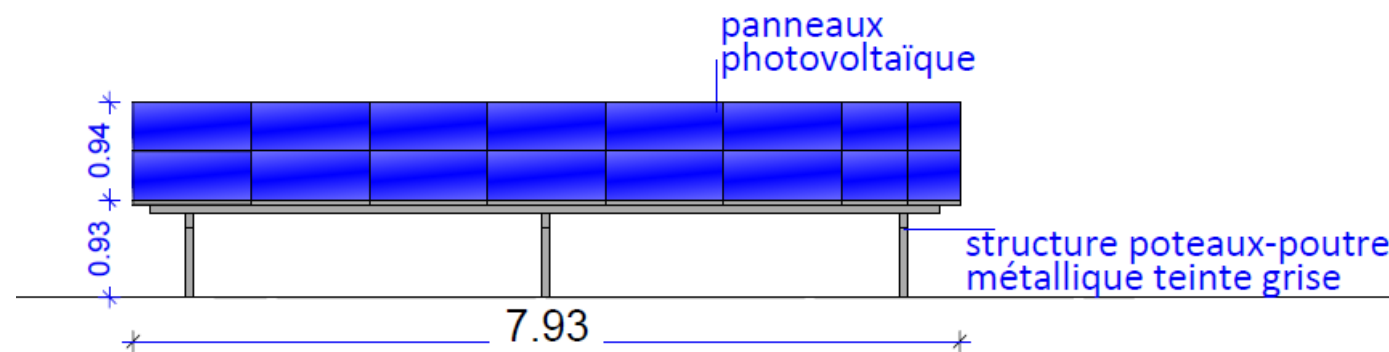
Plan de principe des façades Ouest et Est (Source : Permis de construire du projet, mai 2022)
